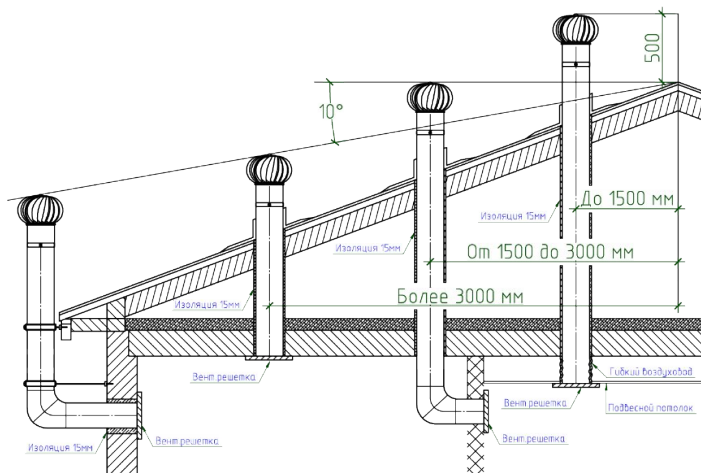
Схема установки ротационных дефлекторов на вентиляционные трубы круглого сечения.
